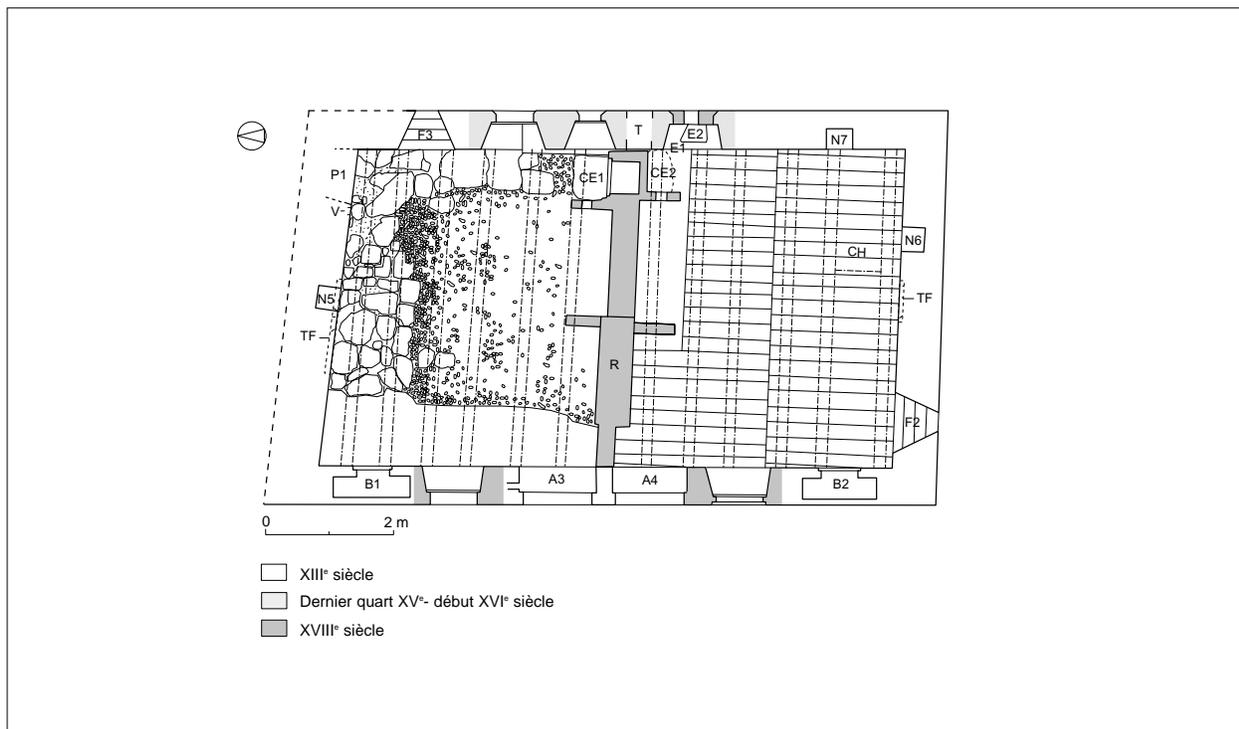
MAISONS JUMELLES N° 1. Plan de l'étage. Relevé V. Rousset, 2001.
